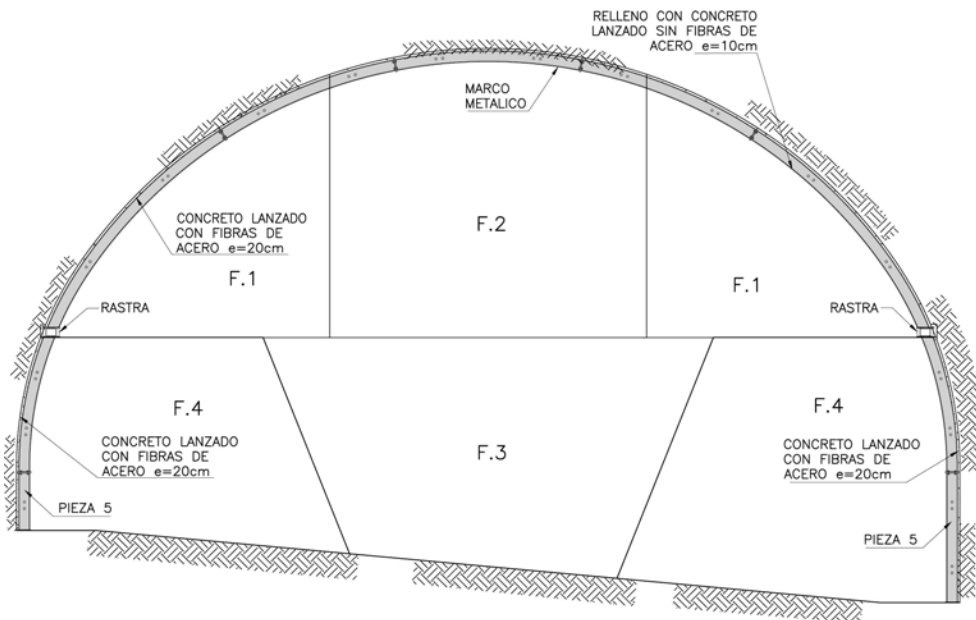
Esquema constructivo para la Condición Geotécnica D^(c).
